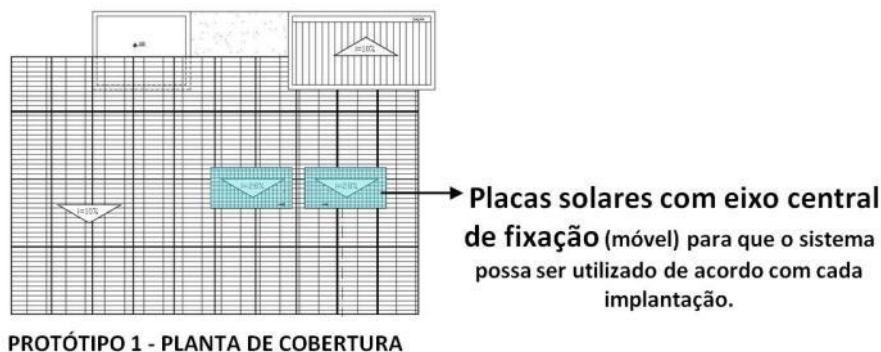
Planta de cobertura com proposta de aquecimento solar
